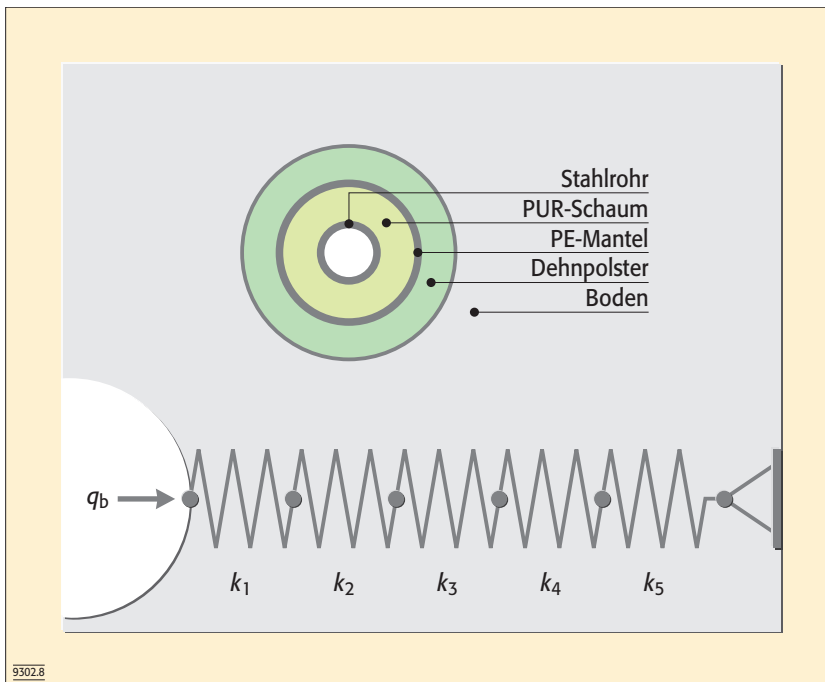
Gedankenmodell für laterale Bettung erdverlegter Fernwärmeleitungen
